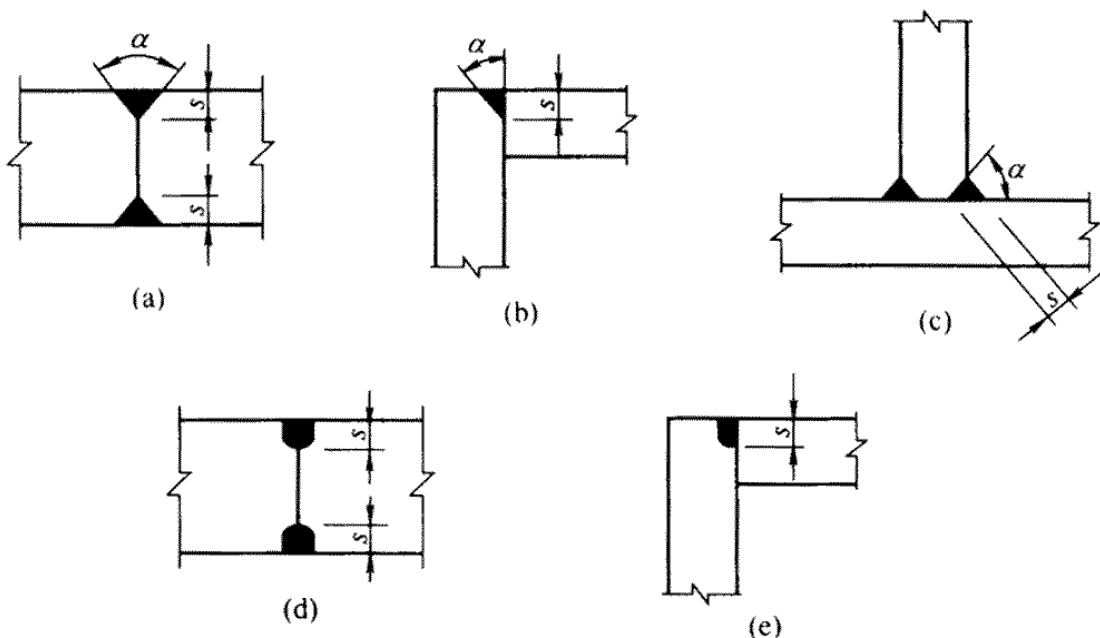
部分焊透的对接焊缝和其与角焊缝的组合焊缝截面
